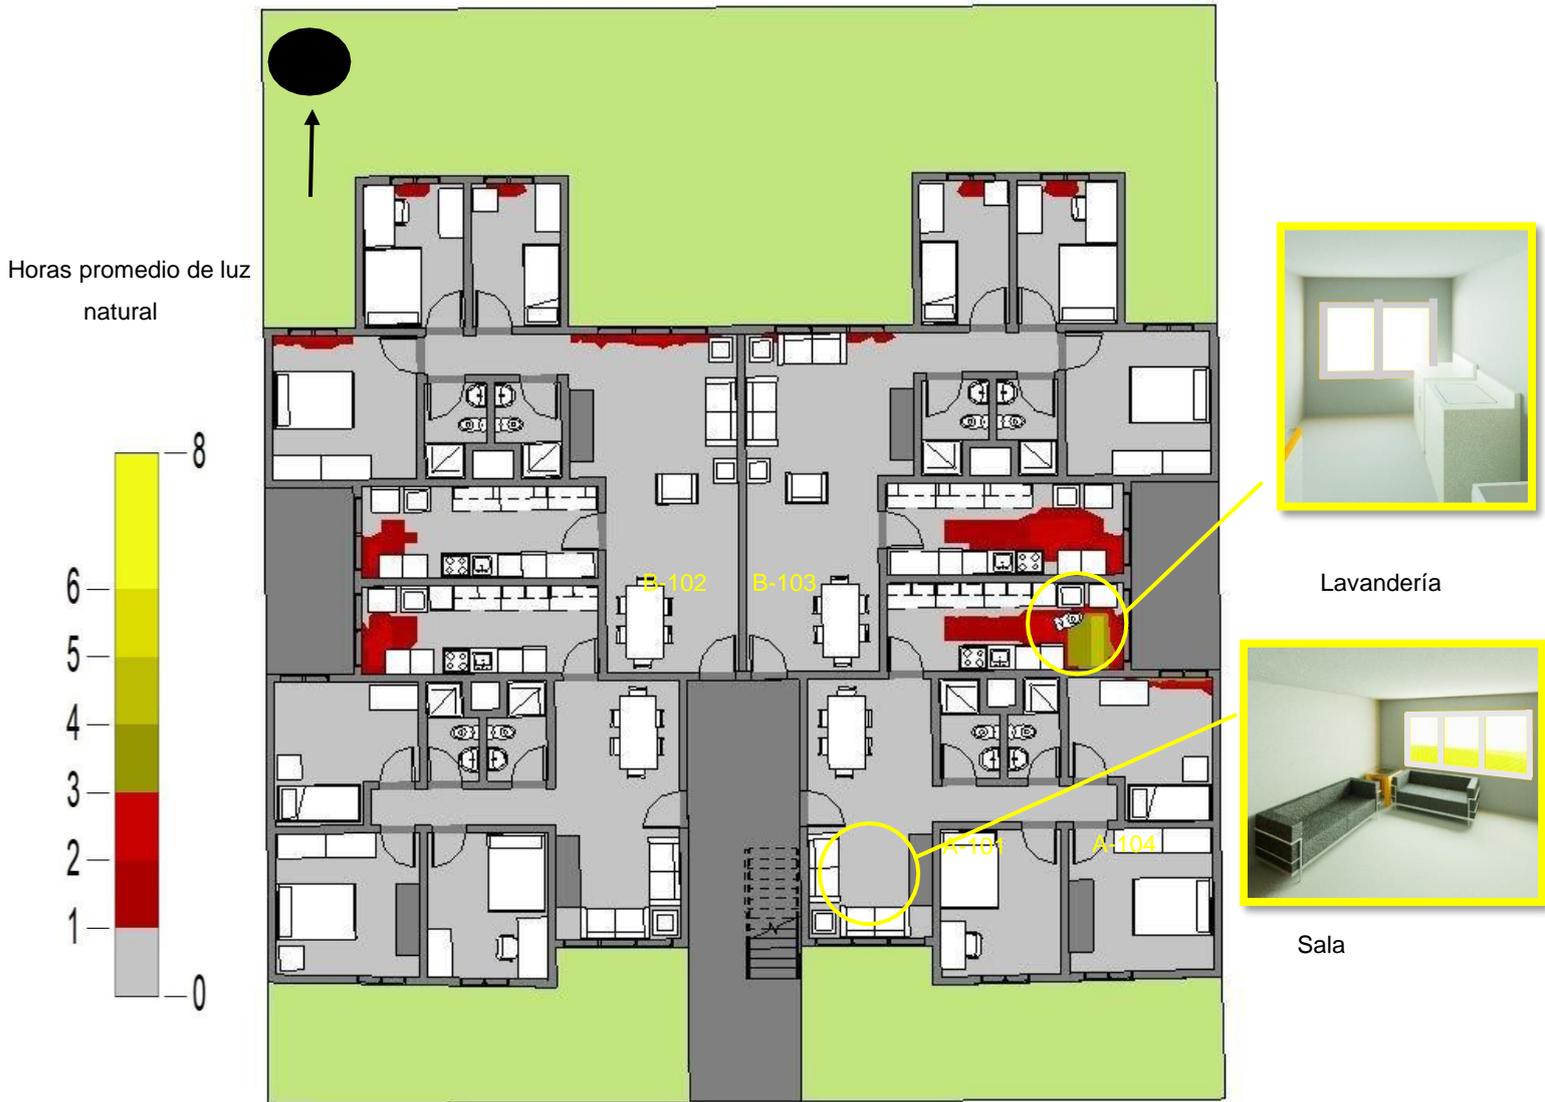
Planta típica-Fachada nor-oeste-Nivel 1 (ver lámina L-02).
